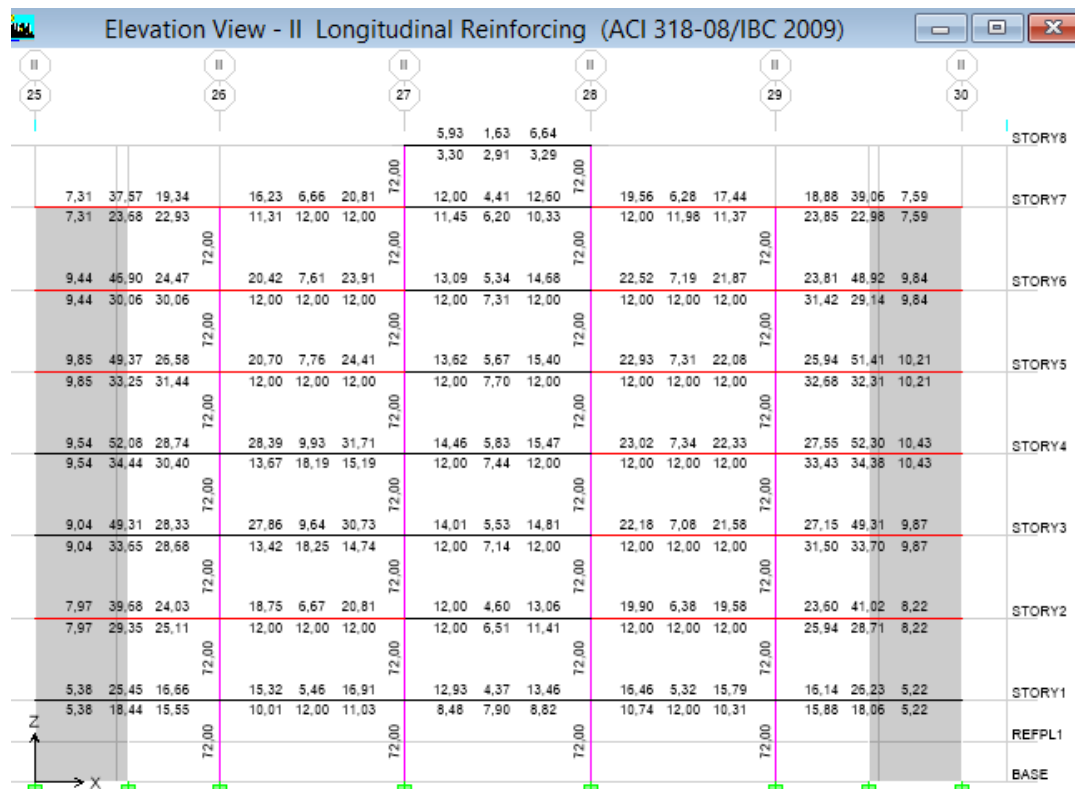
Acero en Vigas y Columnas en el Pórtico II – Hospitalización 2- (CEC-2002)
